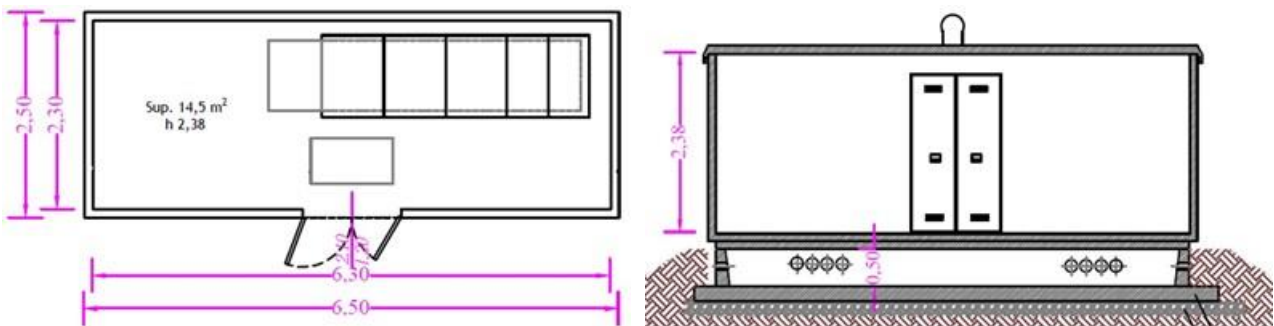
Pianta e profilo delle cabine MT utente 1-2-3-4
